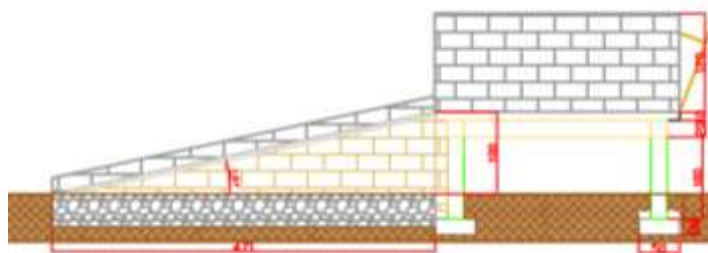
Vista laterale del progetto di un punto di raccolta fisso
